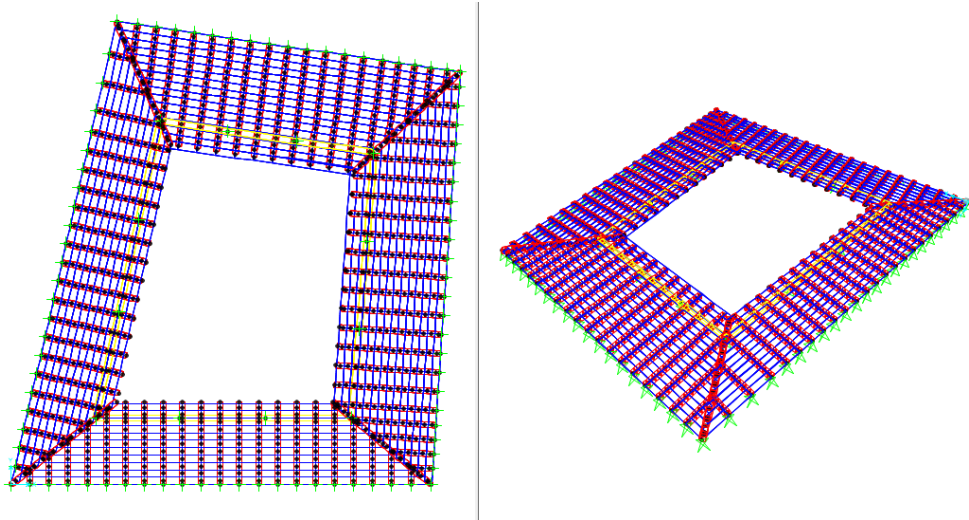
Modelo 3D cubierta Plana en Terraza - SAP2000. Fuente: Autores
